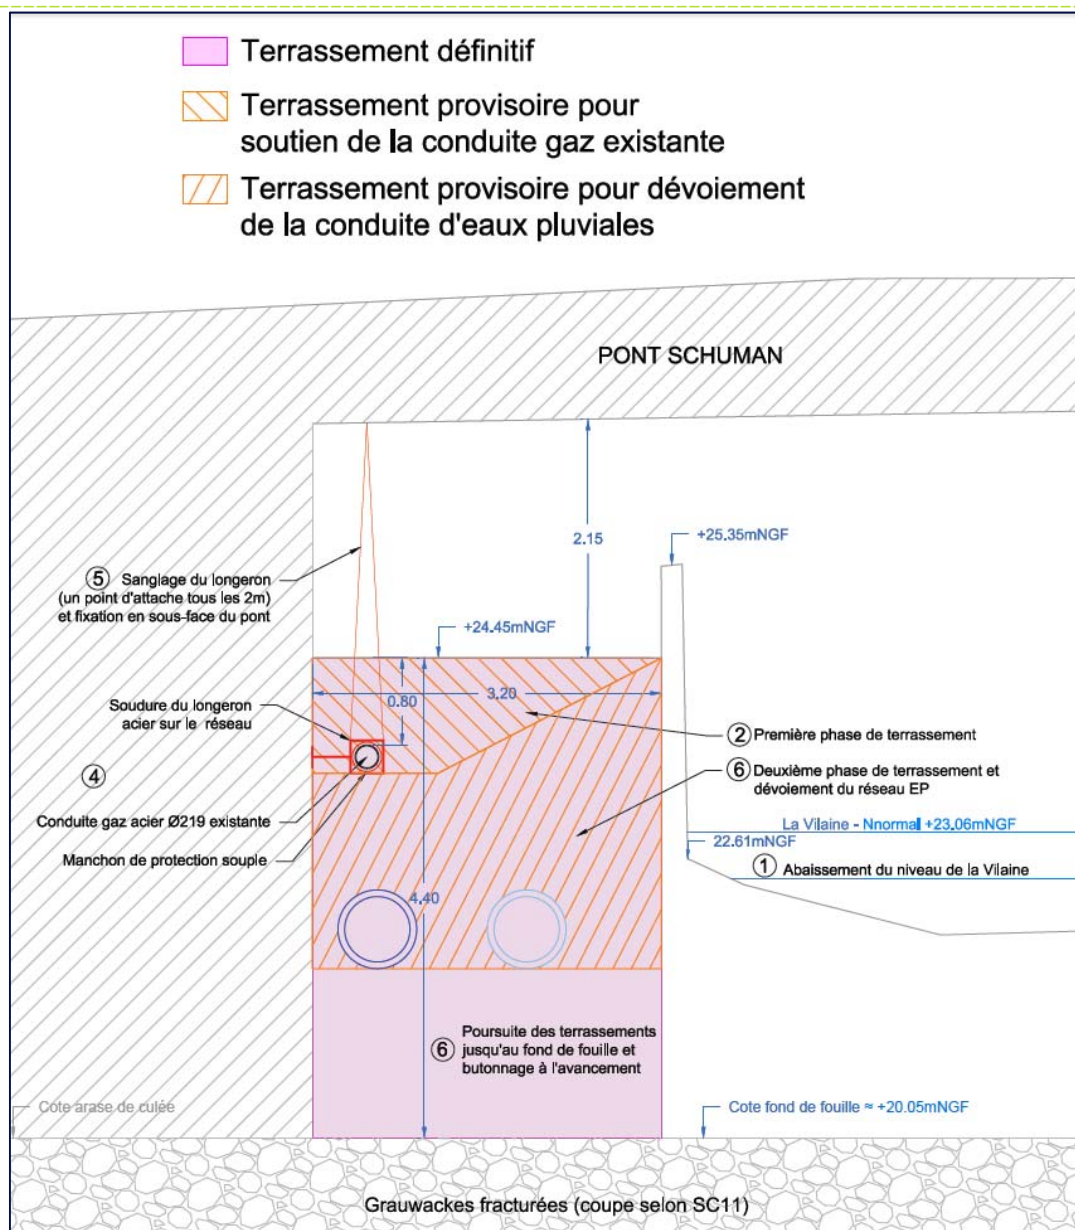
Coupe de principe et phasage des travaux sous le pont Robert Schuman
